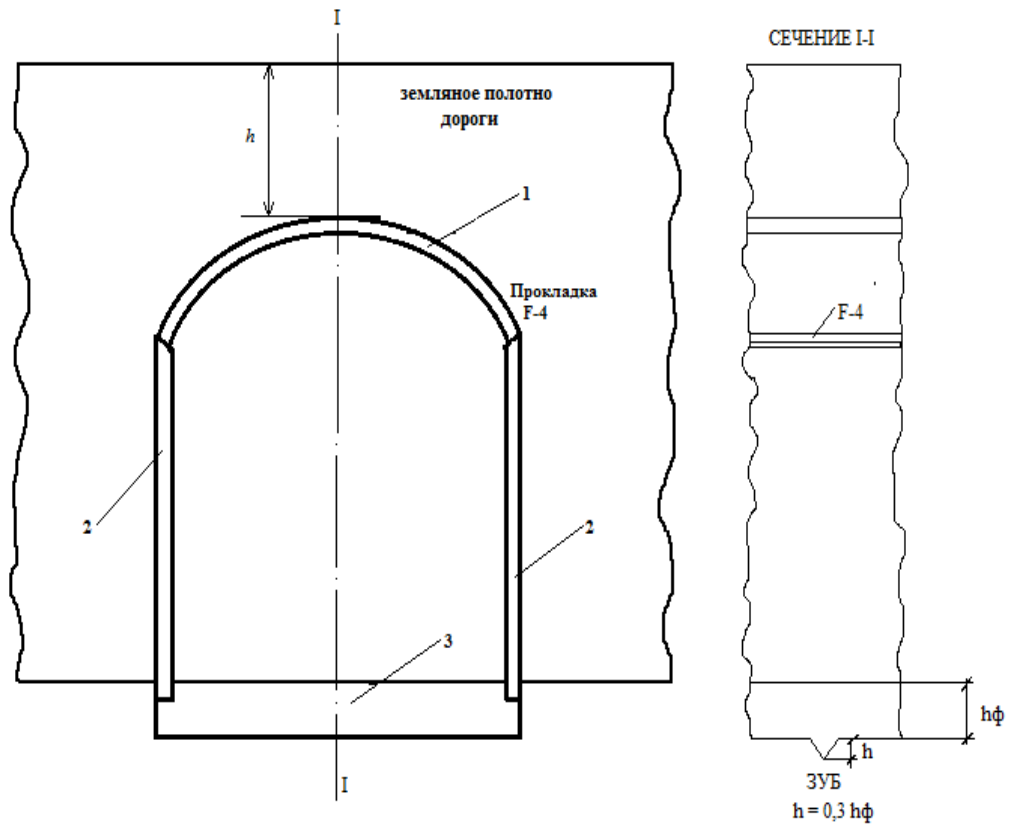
Сборная конструкция водопропускного сооружения для сейсмических районов. 1 – арка, 2 – подпорные стенки, 3 – фундамент.
